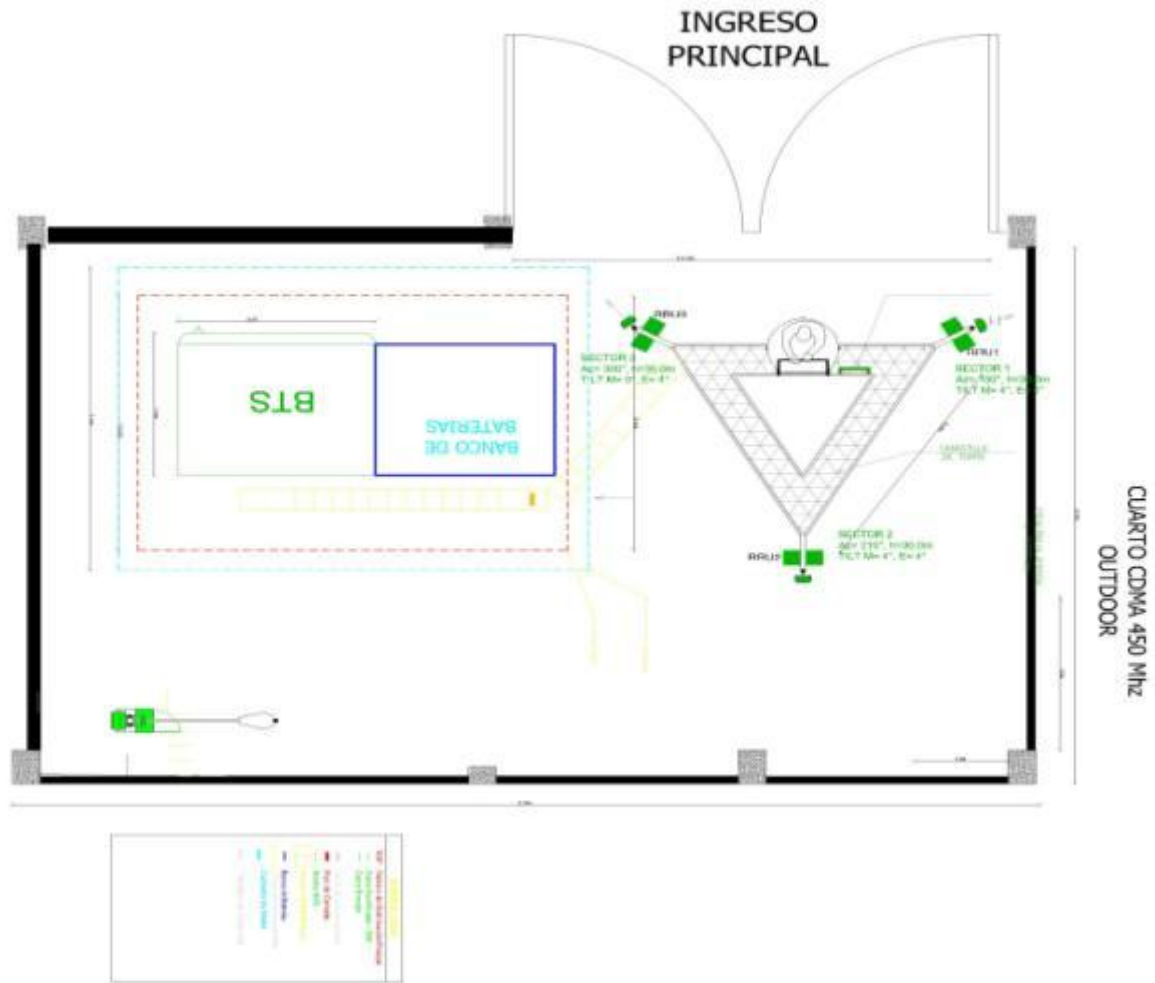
Plano de Ubicación de equipos en la radio base propuesta .
